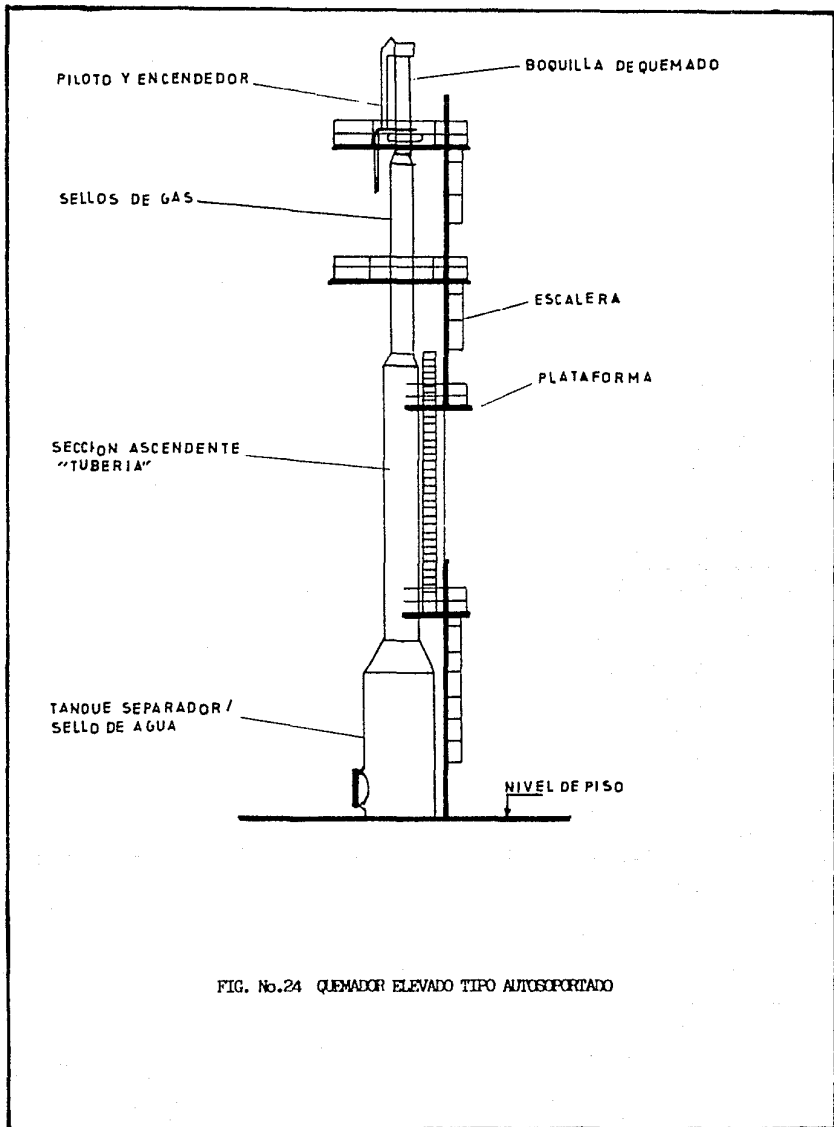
QUEMADOR ELEVADO TIPO AUTOSOPORTADO
